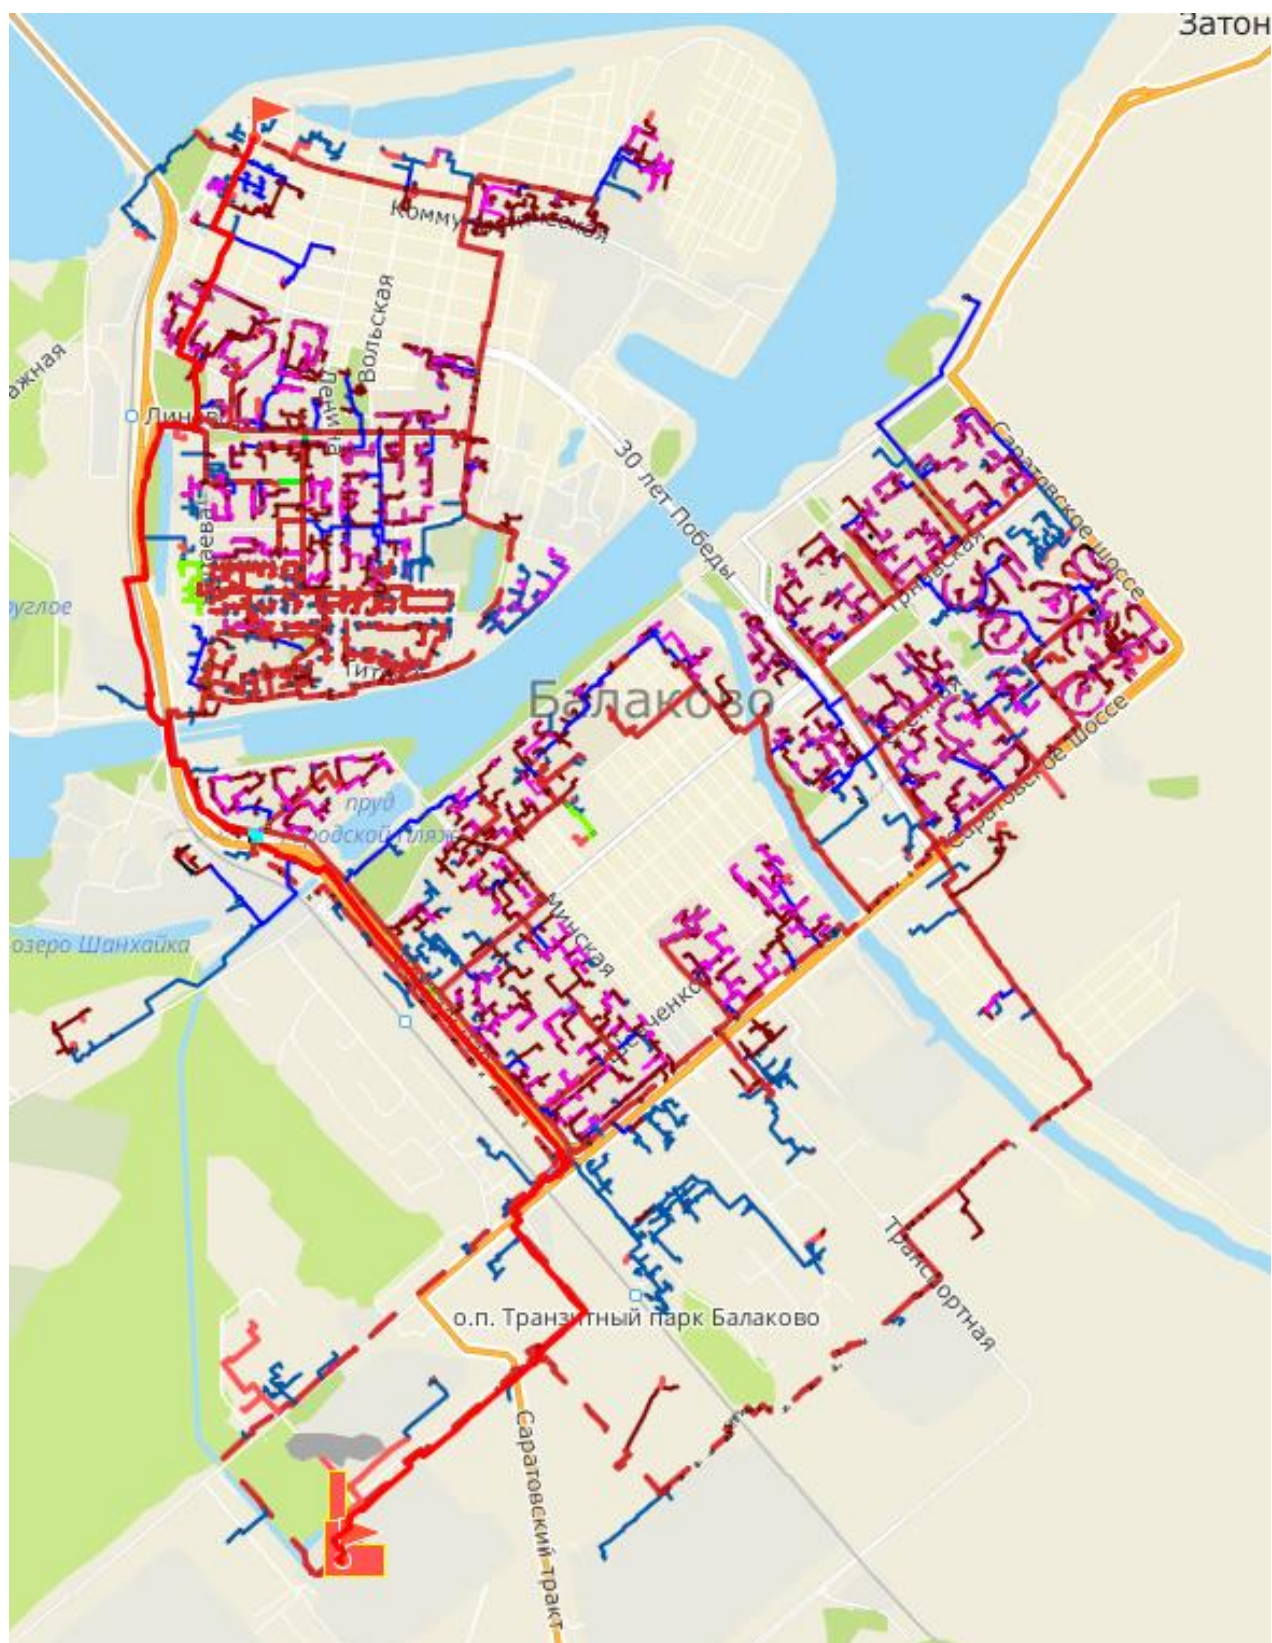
Расчетная схема участка тепловой сети от Балаковской ТЭЦ-4 до ТК-6/34
